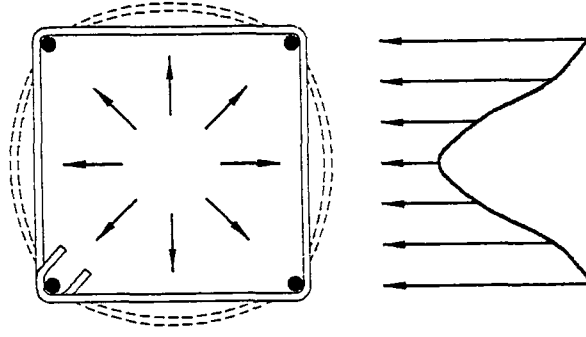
Etriyenin çekirdek betona uyguladığı yanal basınç (Ersoy, 1995).
